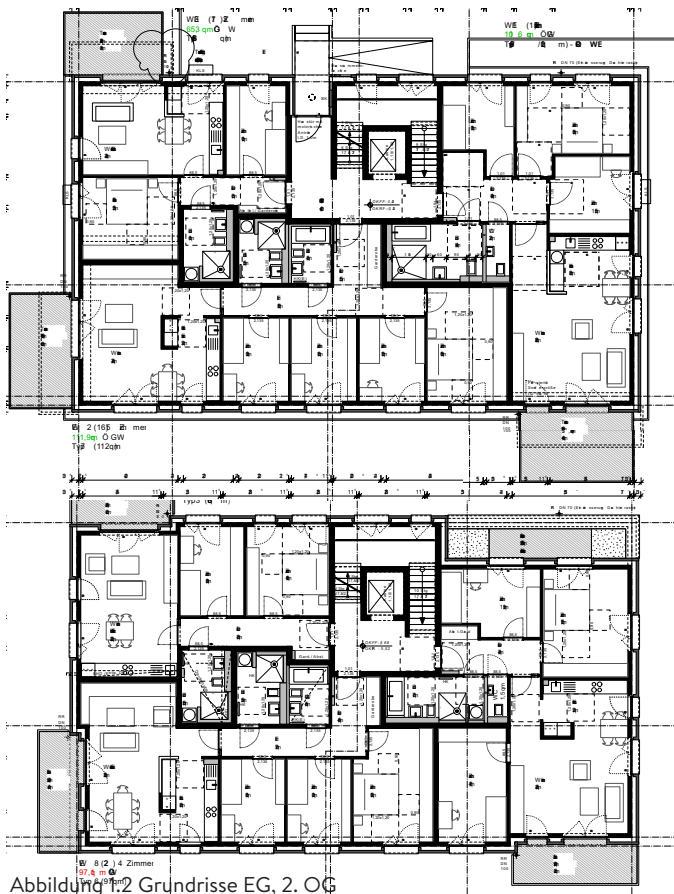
Grundrisse EG, 2. OG
